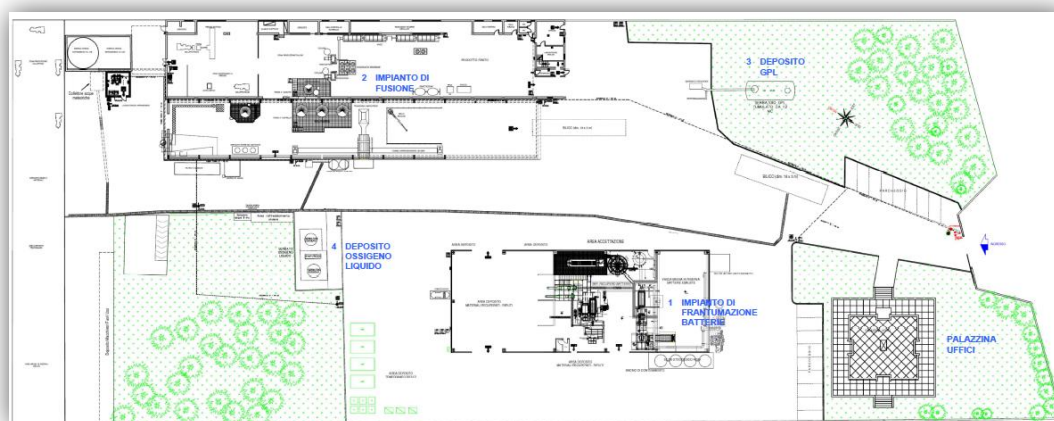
Rischio industriale. Team Italia Srl Planimetria dello stabilimento.
